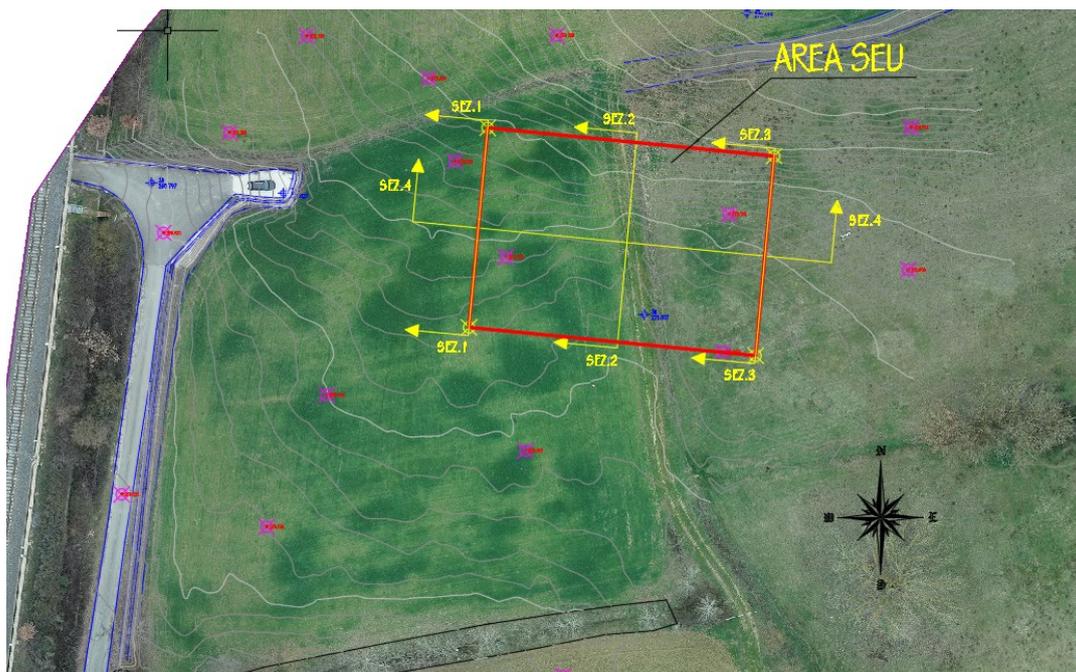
Sezioni e posizionamento SEU su ortofoto
